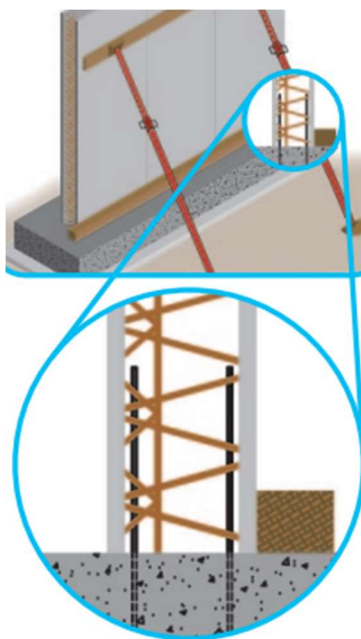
collegamento tra BILASTRA® e ferri di ripresa della fondazione
